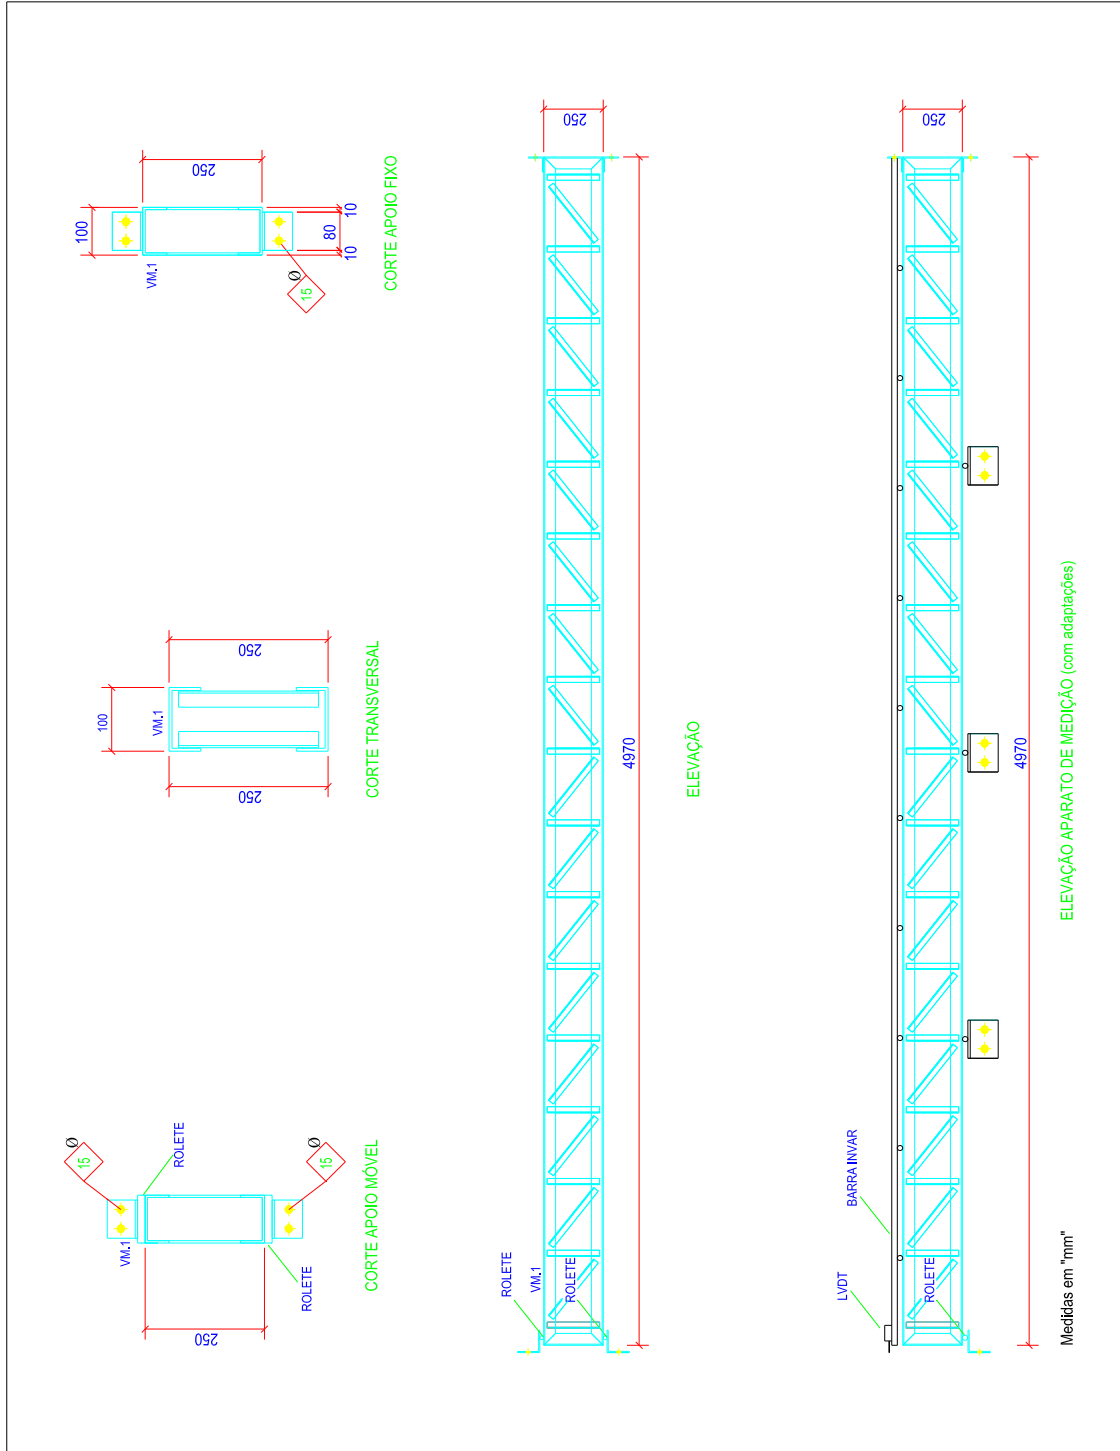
Projeto da viga metálica e aparato de medição - LVDT
